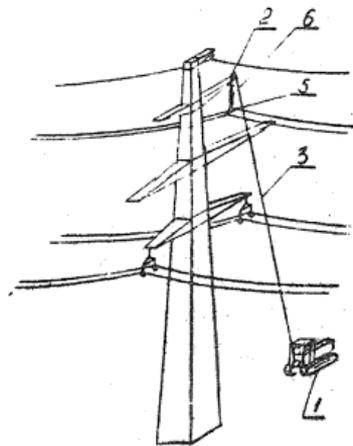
Перекладка проводов верхней траверсы с опусканием на среднюю траверсу опоры.
